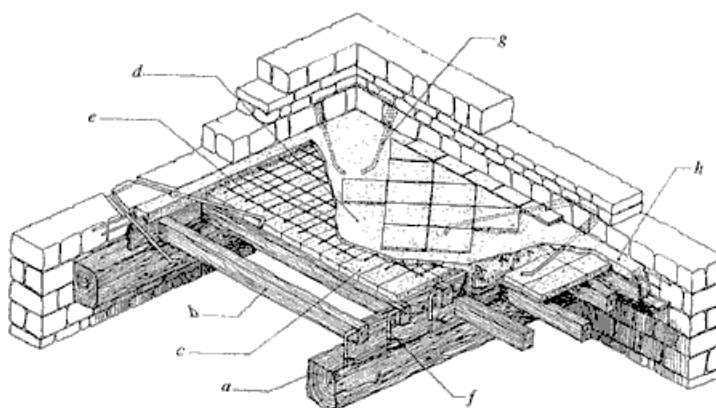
Miglioramento strutturale di un solaio esistente di legno, in un edificio in muratura: (a) travi principali; (b) travi secondarie; (c) piastrelle; (d) soletta di calcestruzzo; (e) rete di acciaio elettrosaldato; (f) spinotti d'acciaio inseriti nel legno e fissati con resina epossidica; (g) staffe d'acciaio per collegare la soletta di calcestruzzo con la muratura; (h) cordolo in c.a. di rigiro.
